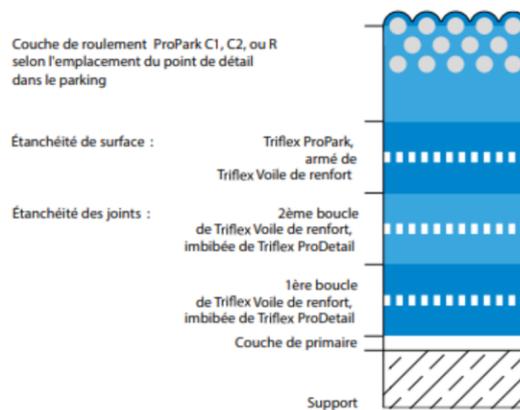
Traitement sur appuis dans le cas des planchers de type D avec dalle de répartition
